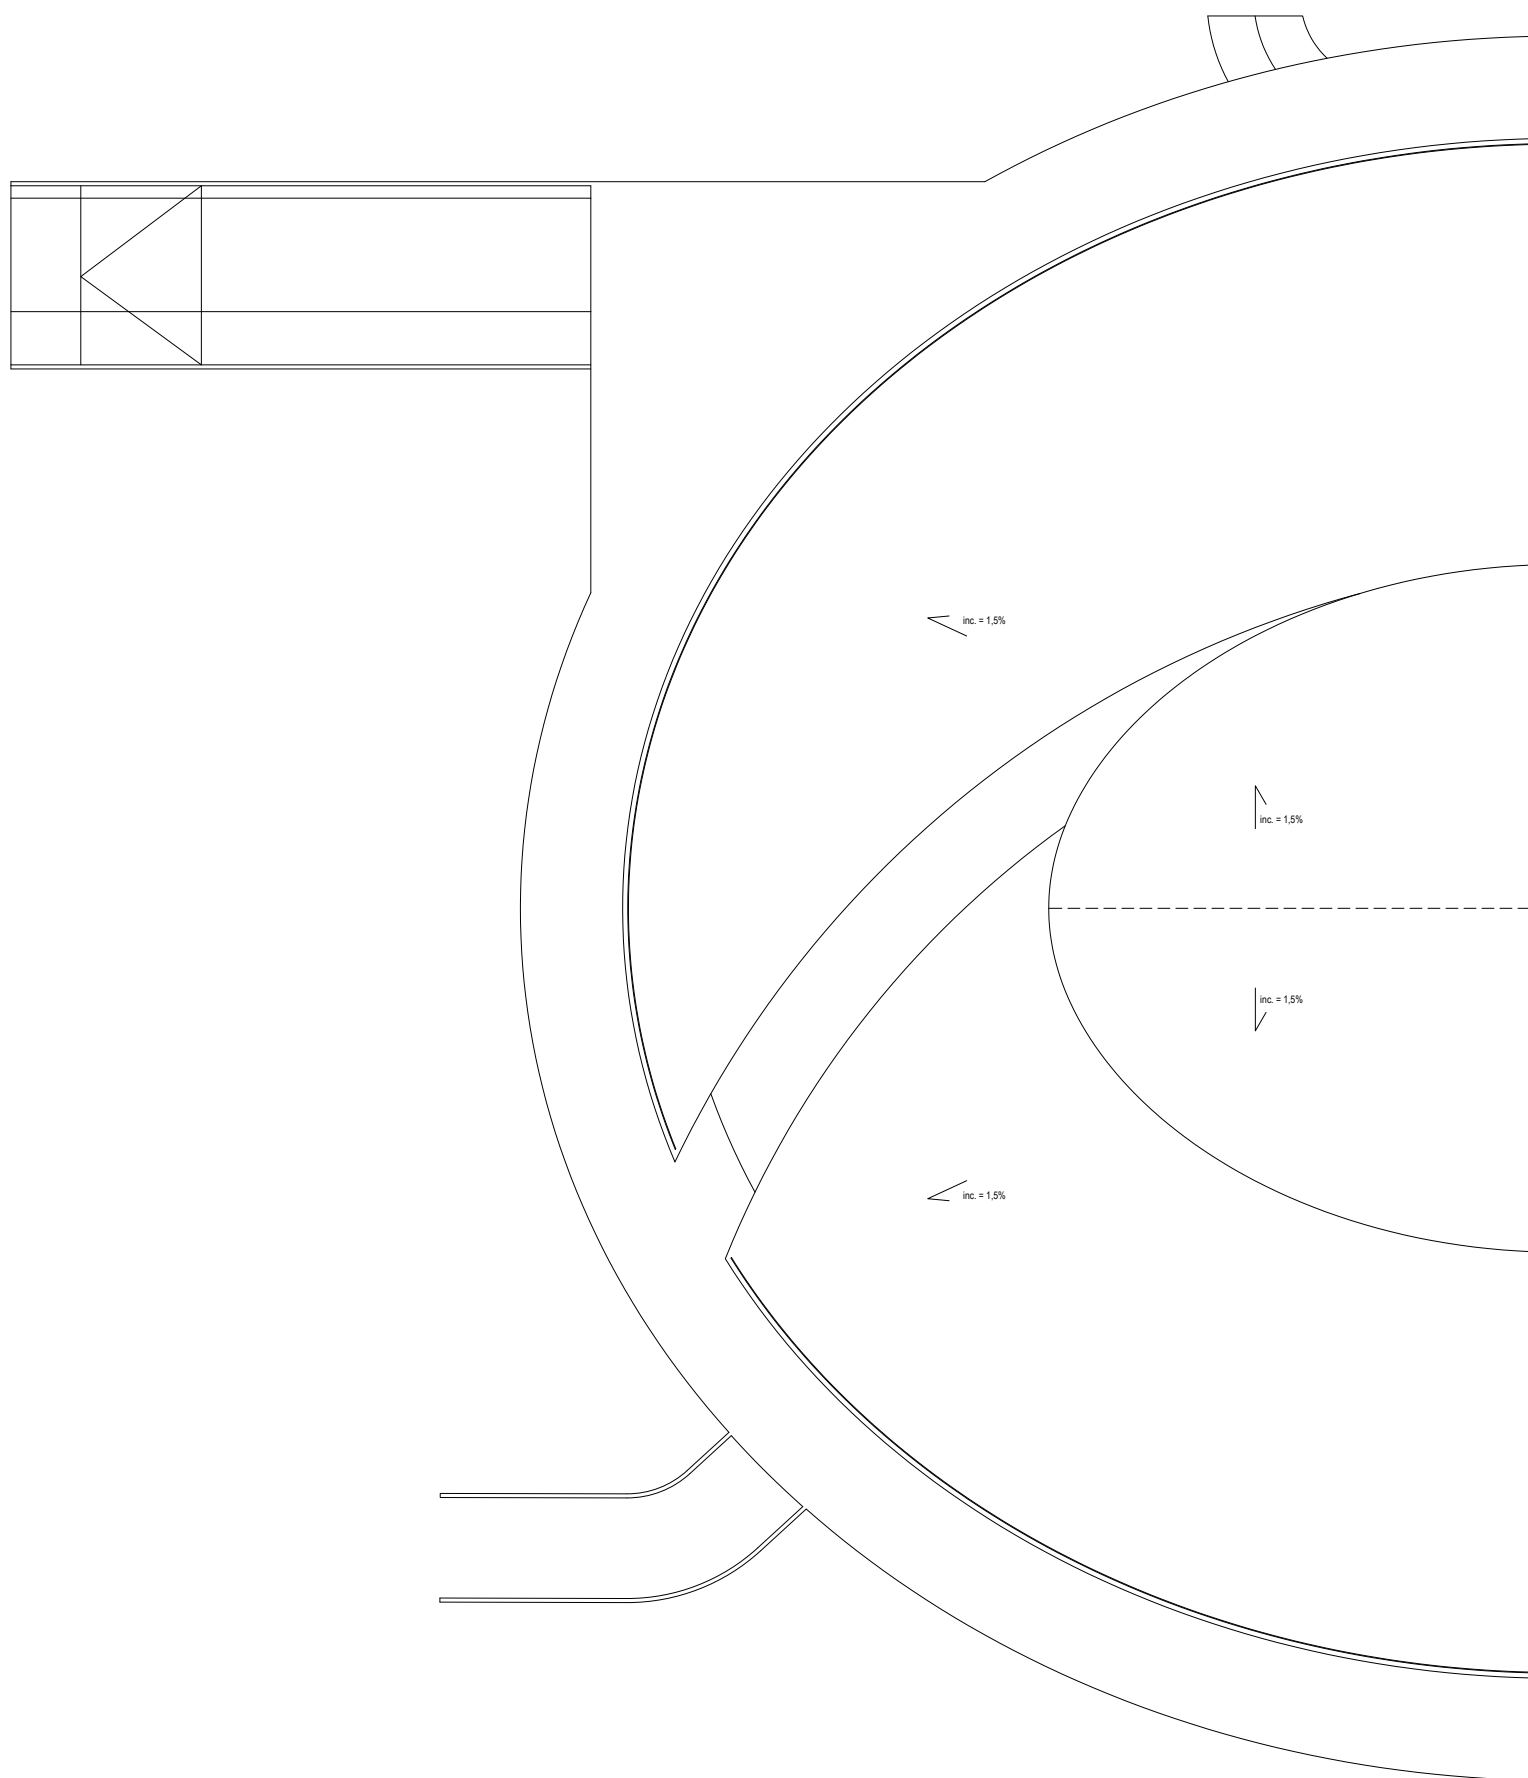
A.1.03 - Planta de Piso 1 - do autor
